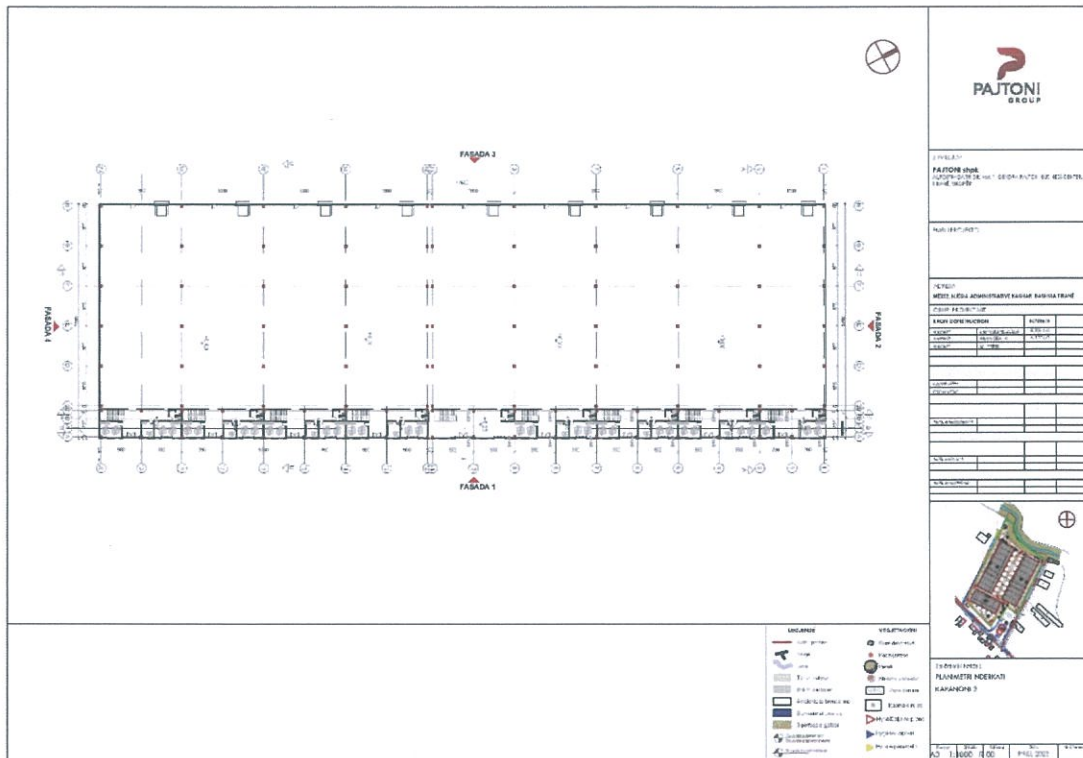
Planimetria e katit të parë të Kapanonit 3.
